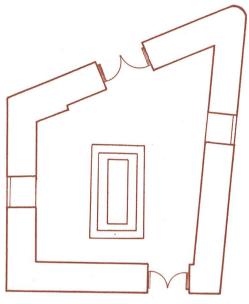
المسقط الأفقى لطوابق مئذنة مسجد التوفيقية مقياس رسم ١ : . ٥
